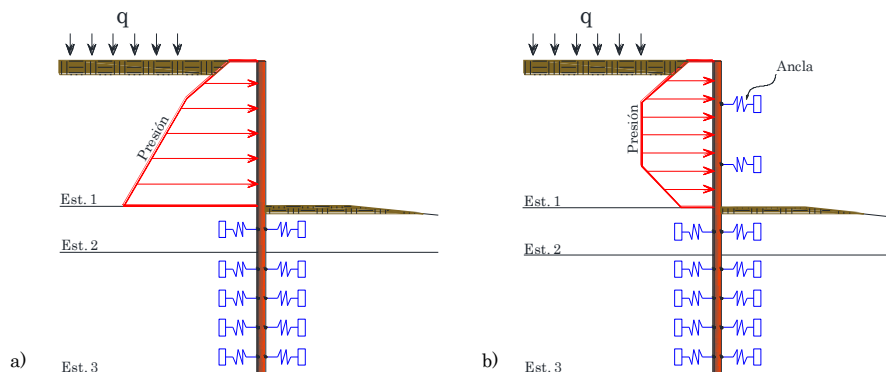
Modelo *py* para un muro en voladizo y anclado.
